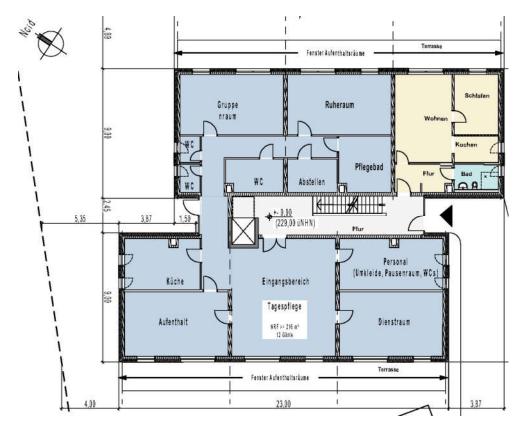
Grundriss Erdgeschoss / Betreutes Wohnen - Tagespflege
